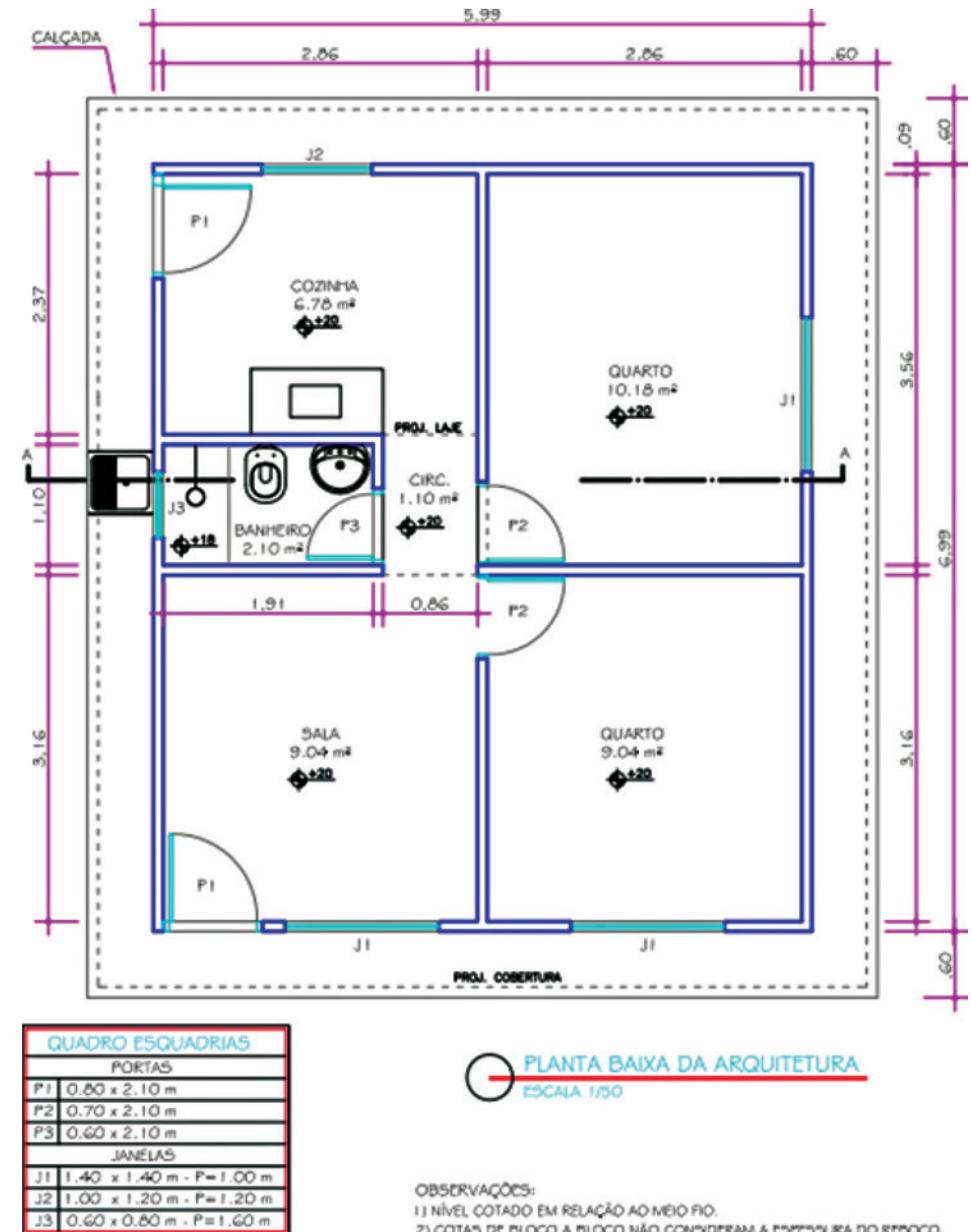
• Planta baixa de arquitetura da obra (CAIXA, 2013)
